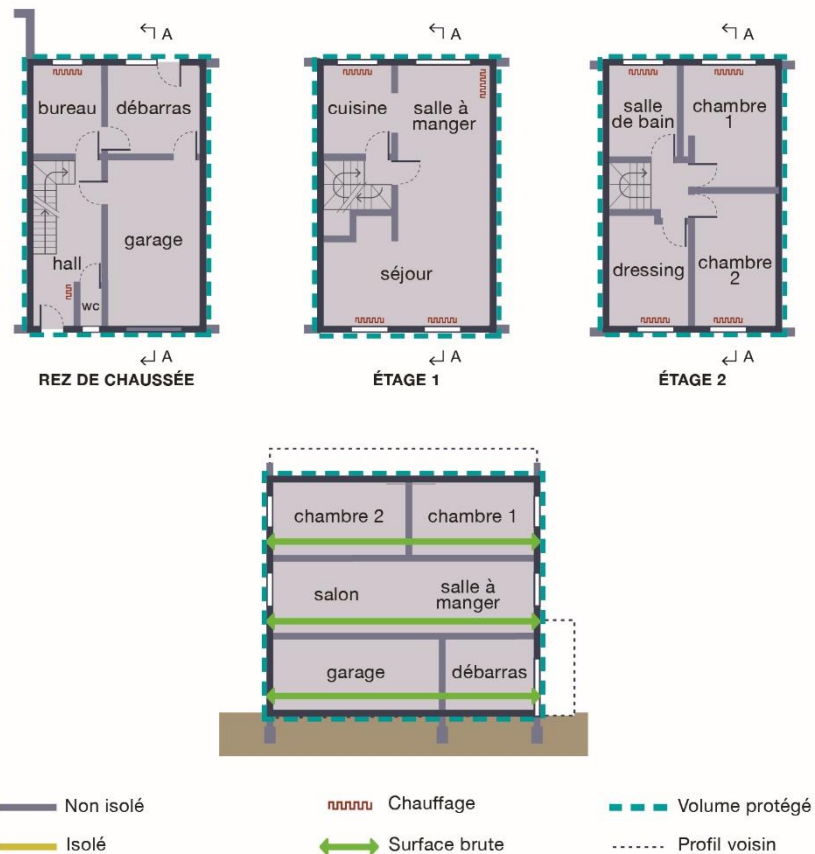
Vue en plan et en coupe d'une maison bel-étage
